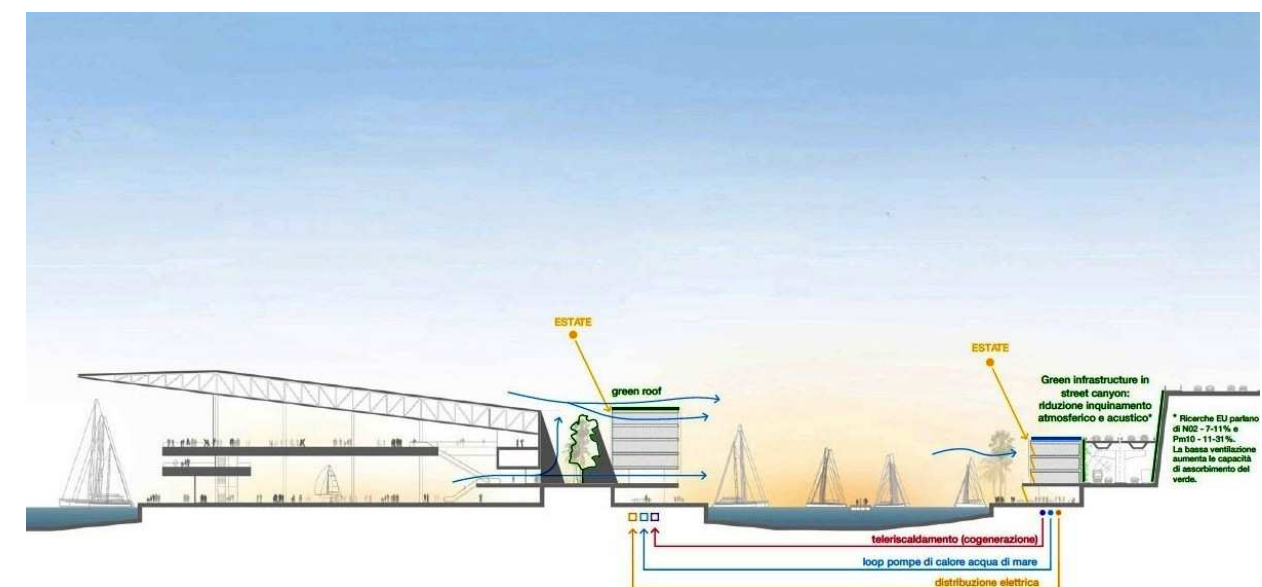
Si condivide lo schema fonti rinnovabili che dovrà essere ulteriormente approfondito nel progetto esecutivo
